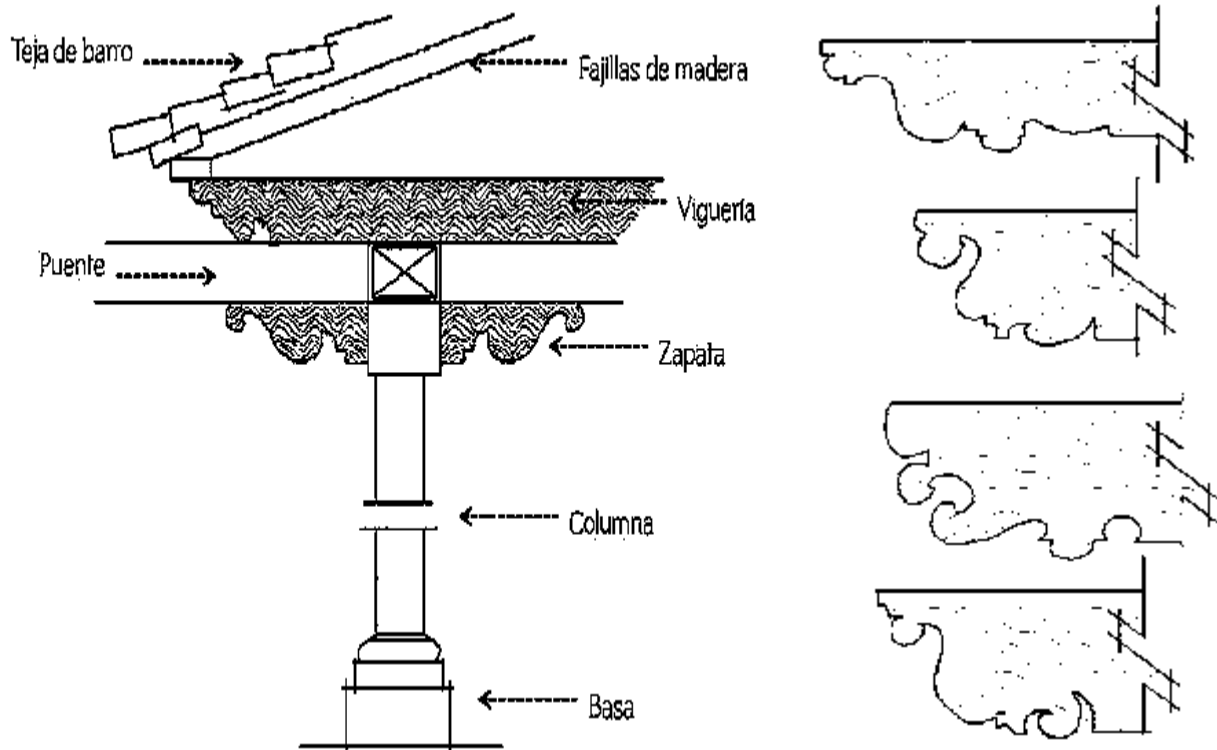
Detalle apoyo aislado, zapatas y puente sobre el que se desplanta la viguera. Fuente: J. J. Segura Granados. Con datos de las Instrucciones relativas para las construcciones en las avenidas 20 de Noviembre y Francisco I. Madero.
